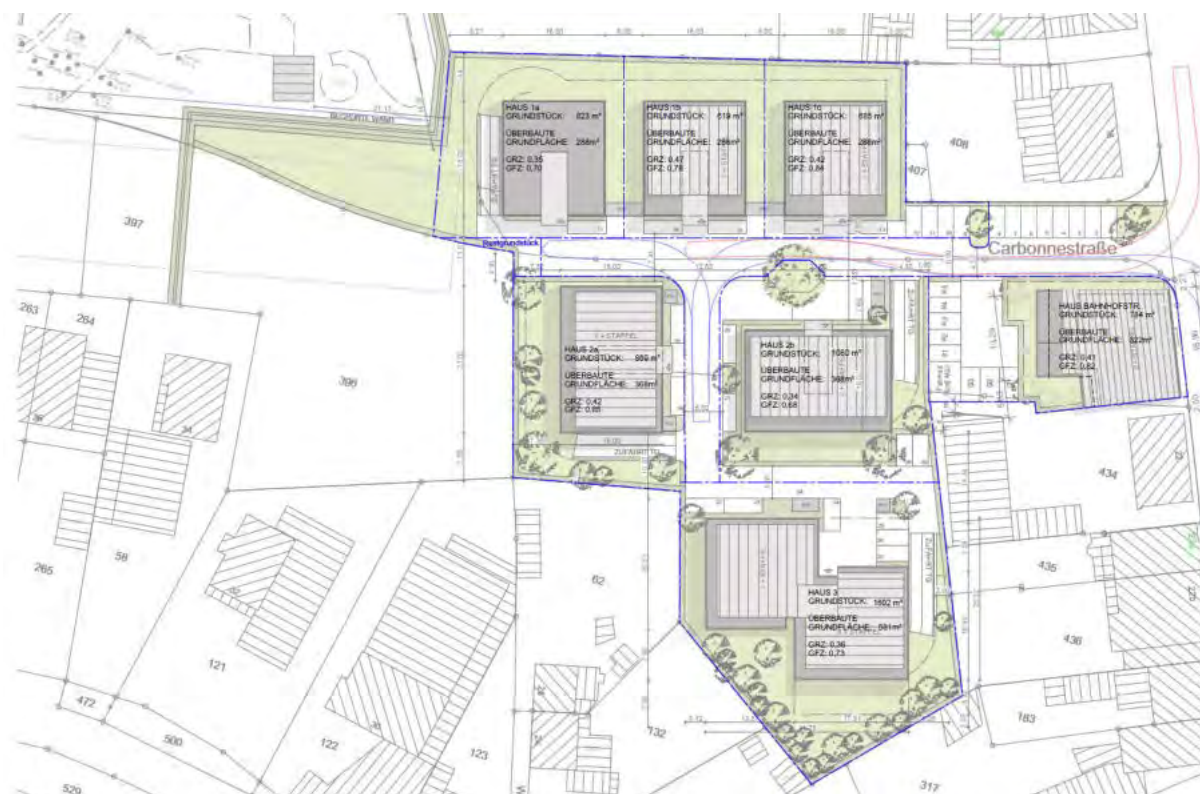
städtebaulicher Entwurf, Otten Architekten GmbH, Lageplan, 28.05.2019
